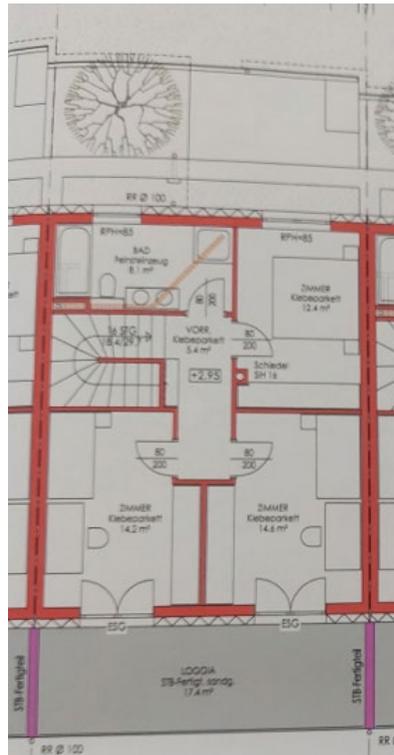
Top 3 - Grundriss OG | Einreichplan | 26.08.2014
